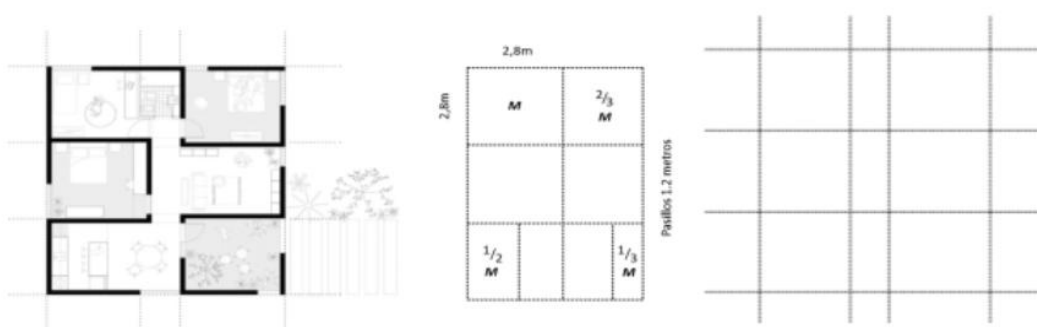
Proyecto Vivir” sistema de construcción reticular con DfD. Fuente: PREMOLDEADOS SAS, 2024
